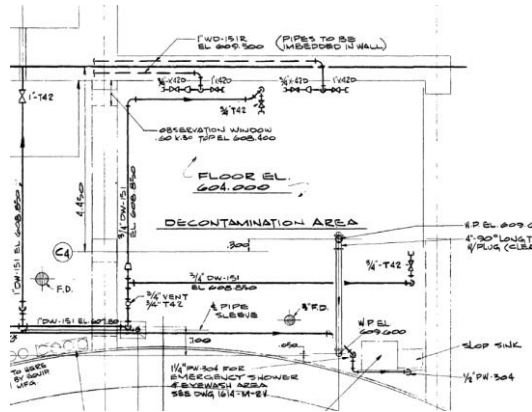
Elementos embebidos en edificio auxiliar. Antigua planta de embidonado
